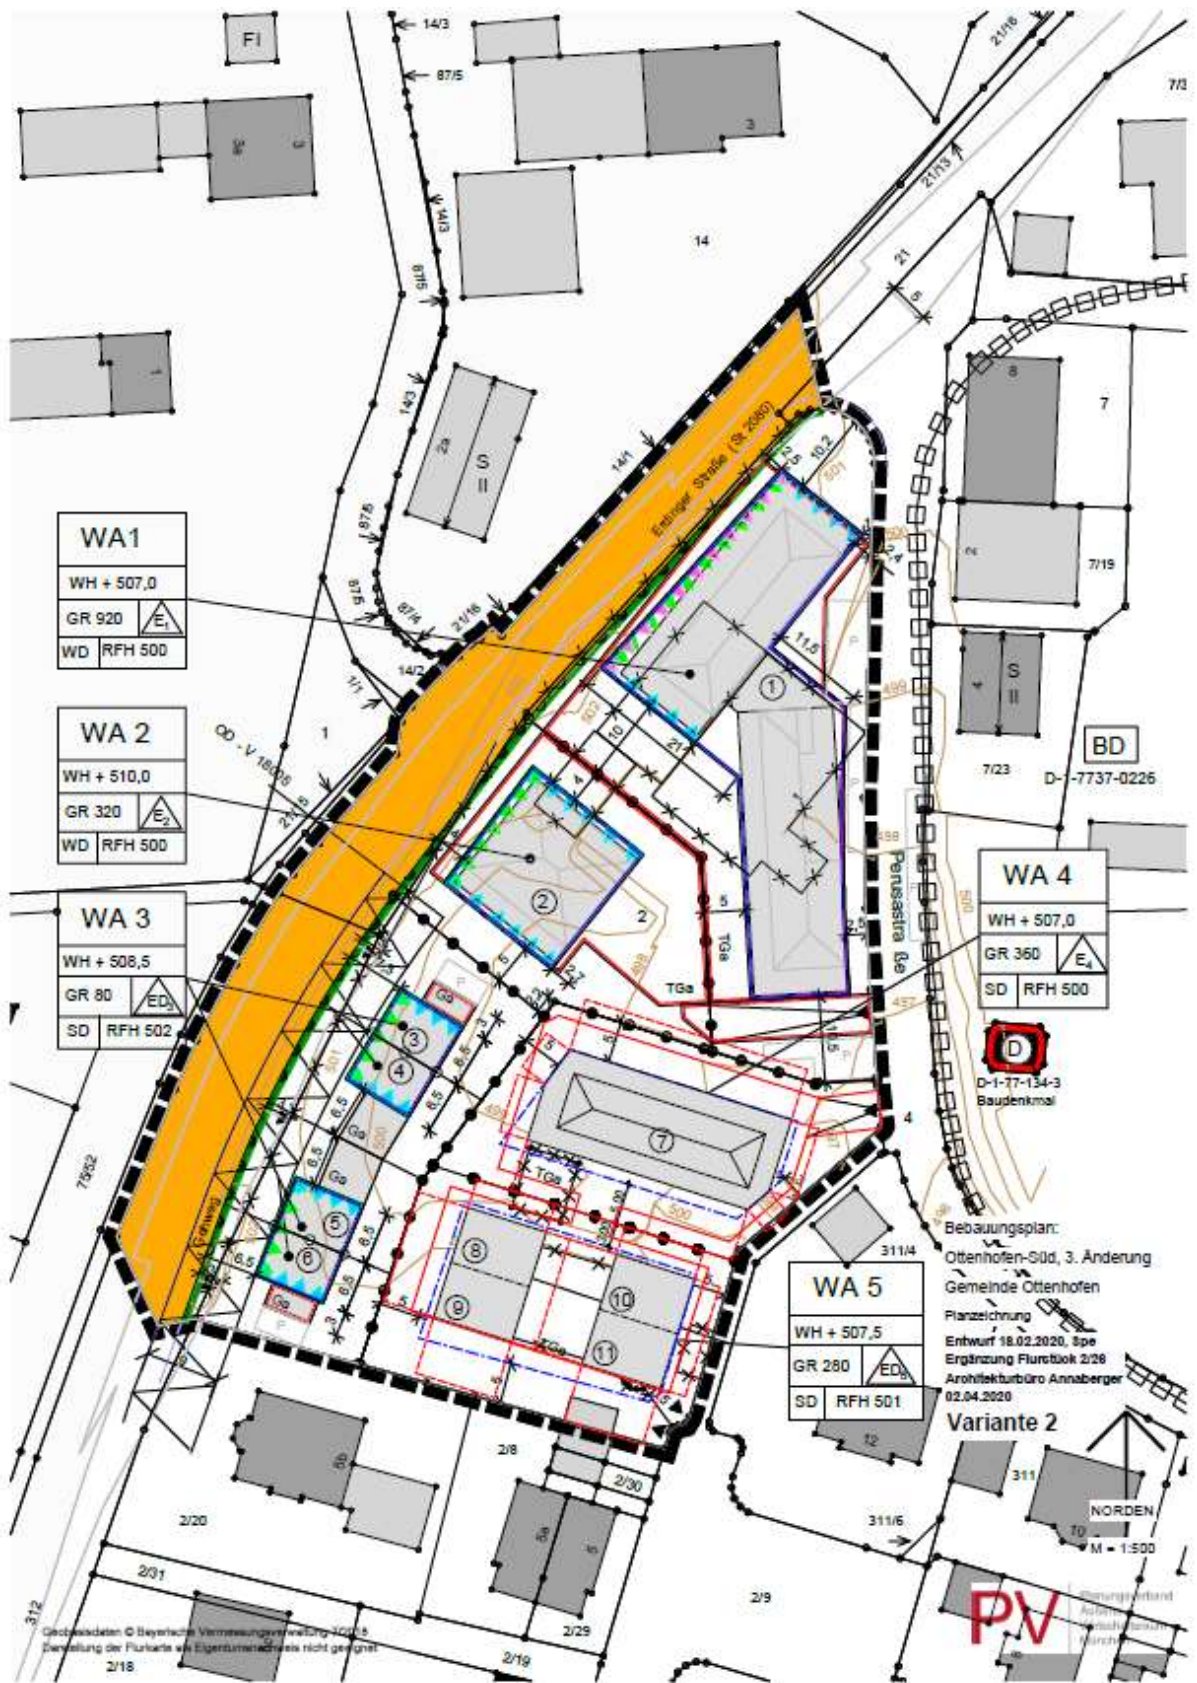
Bebauungsplan Lösungsvorschlag Bürger 1
